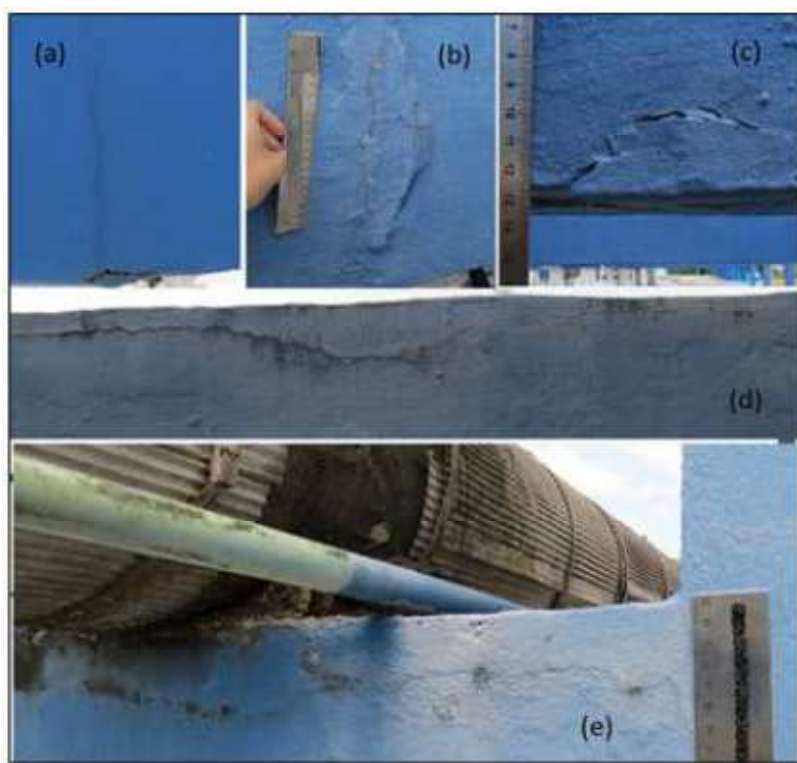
Manifestações patológicas nas vigas Vierendeel de dano médio: (a, b, c) fissuras e deslocamentos parciais do concreto, (d) fissura longitudinal à armadura com manchas de infiltração, (e) detalhe do encontro entre a tubulação e a viga.
